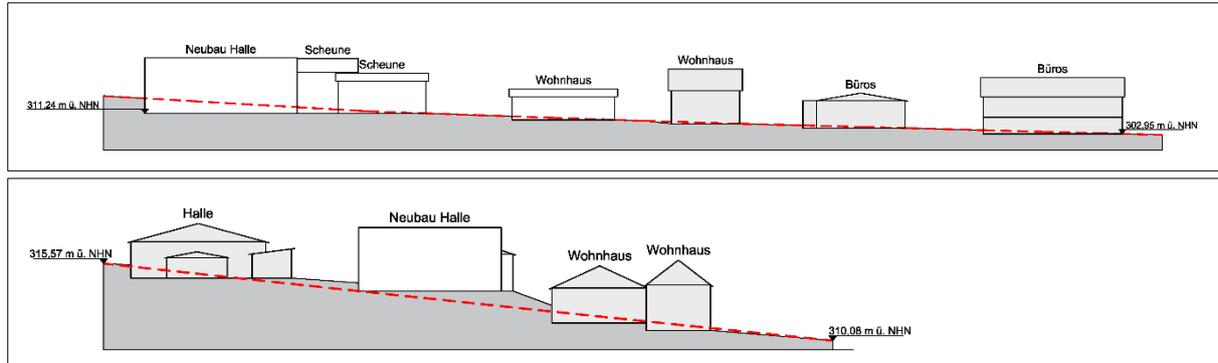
Schemaschnitte durch das Plangebiet mit Blick aus Süden (oben) und Westen (unten)
